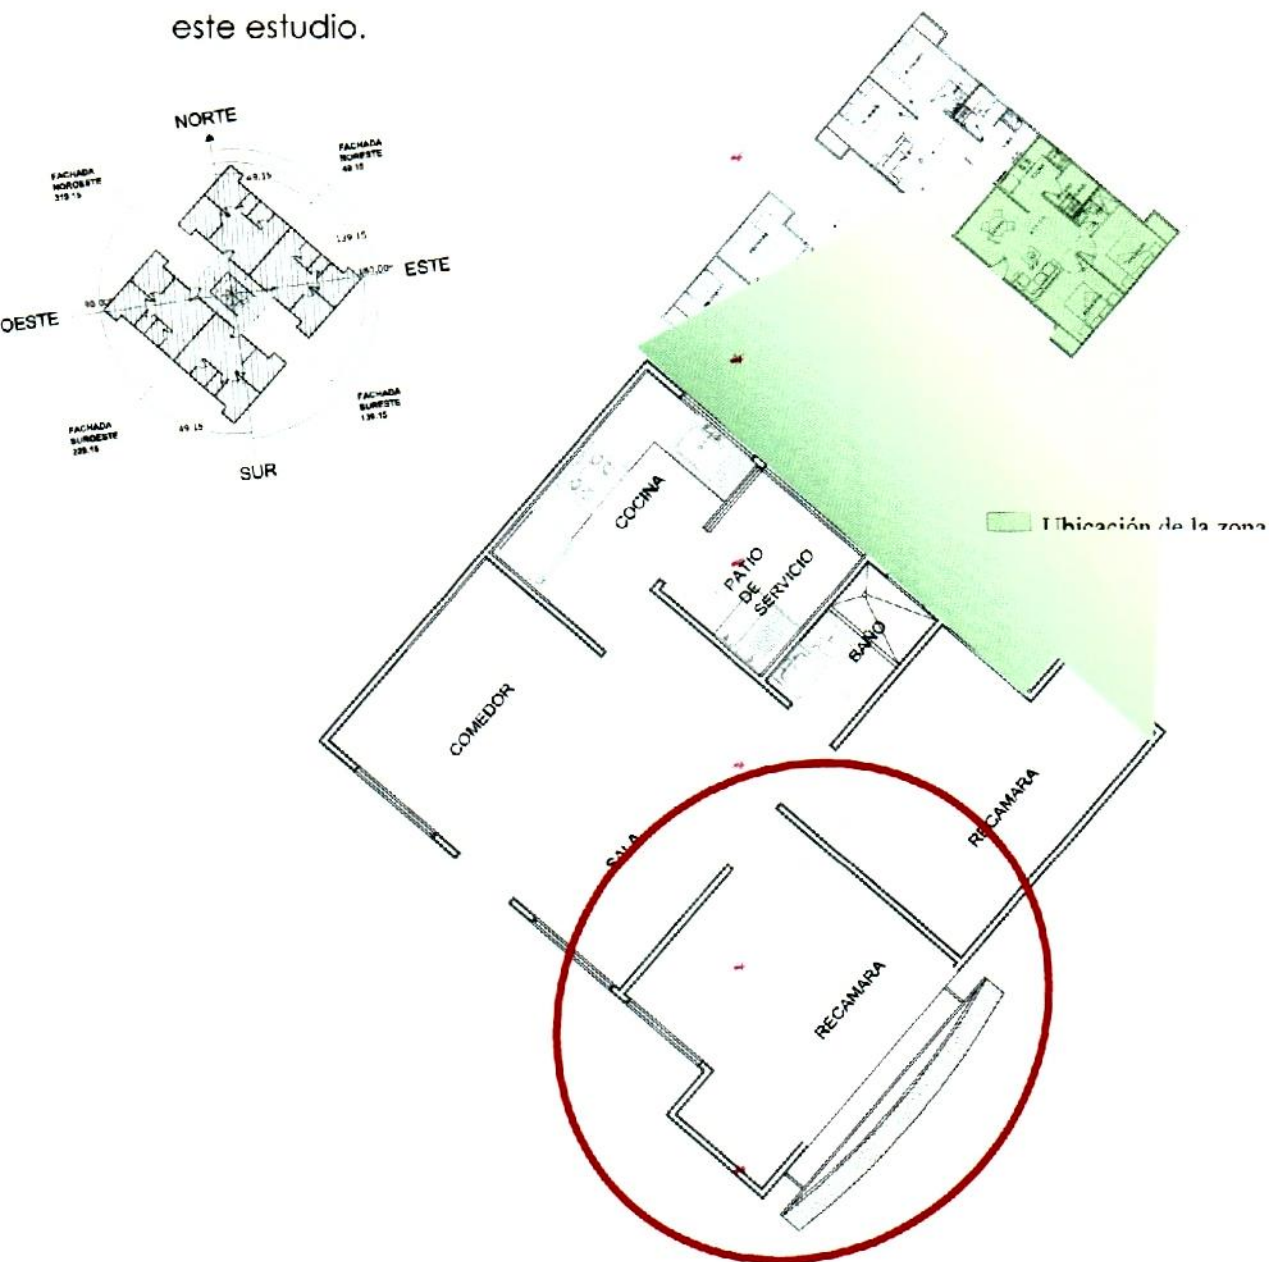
Planta arquitectónica indicando la recámara que se estudió.
